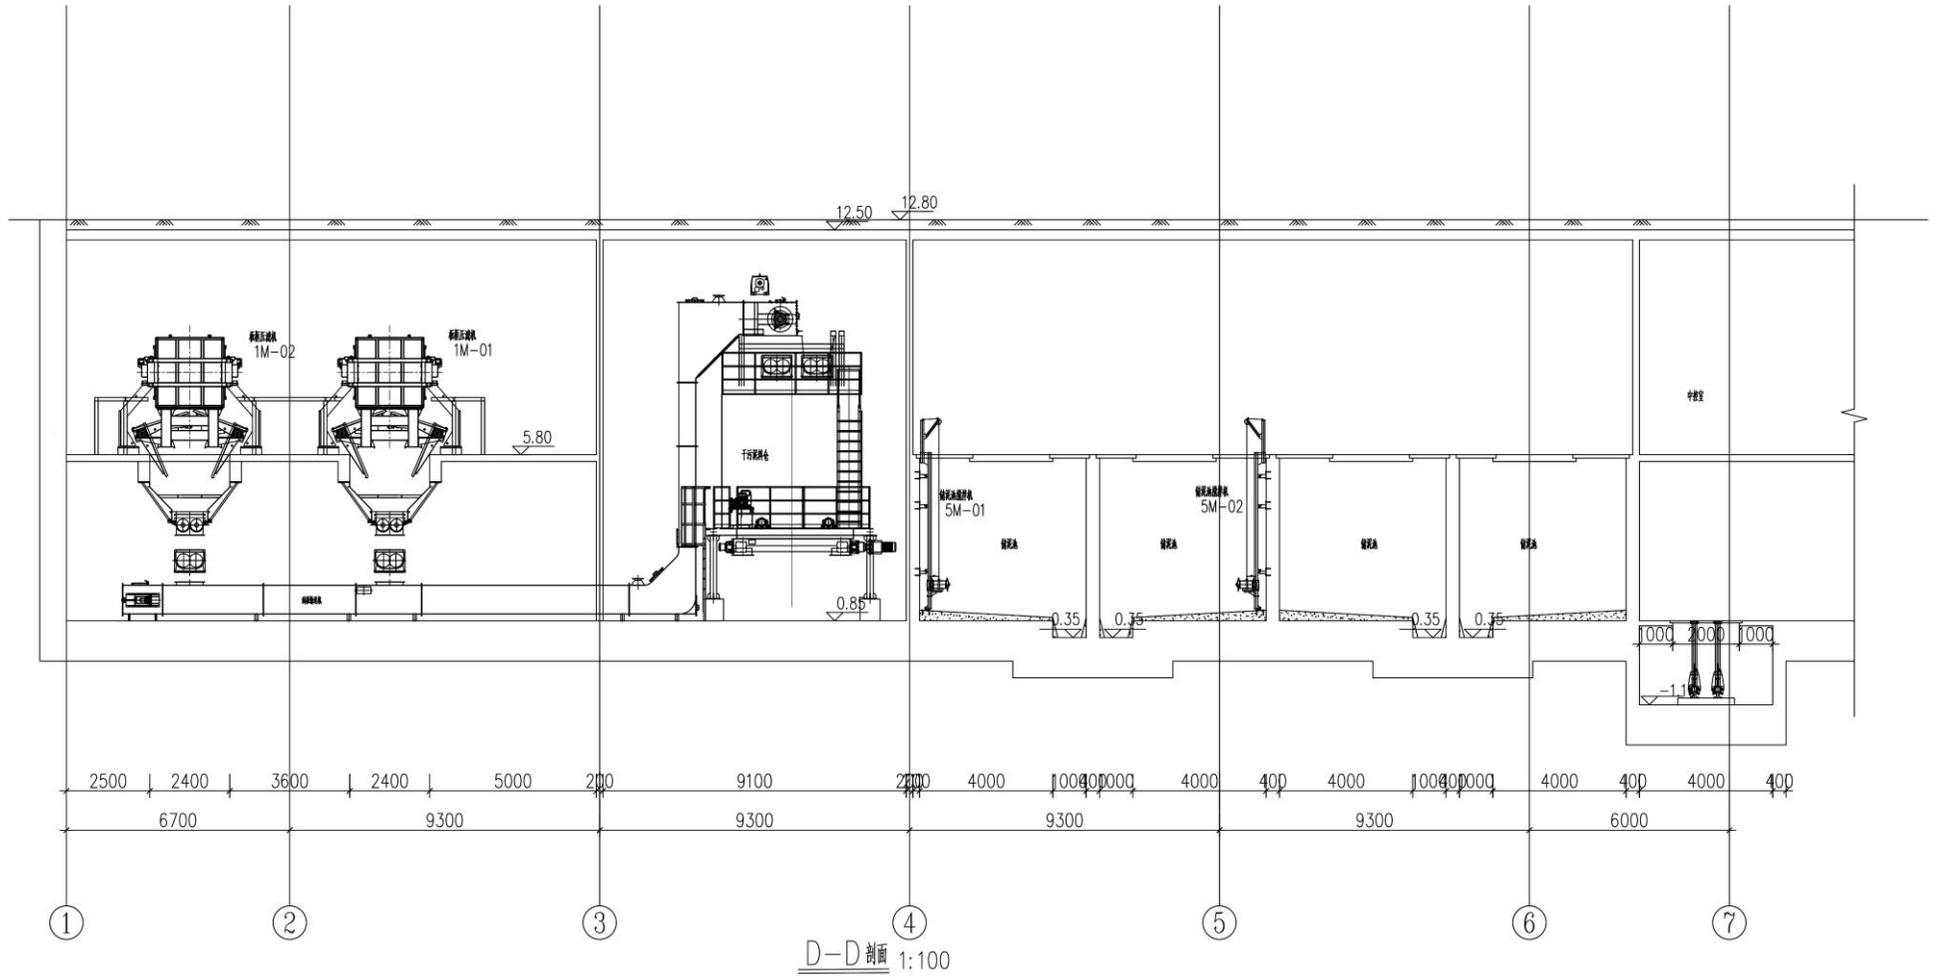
污泥脱水车间剖面图 (D-D 断面)
